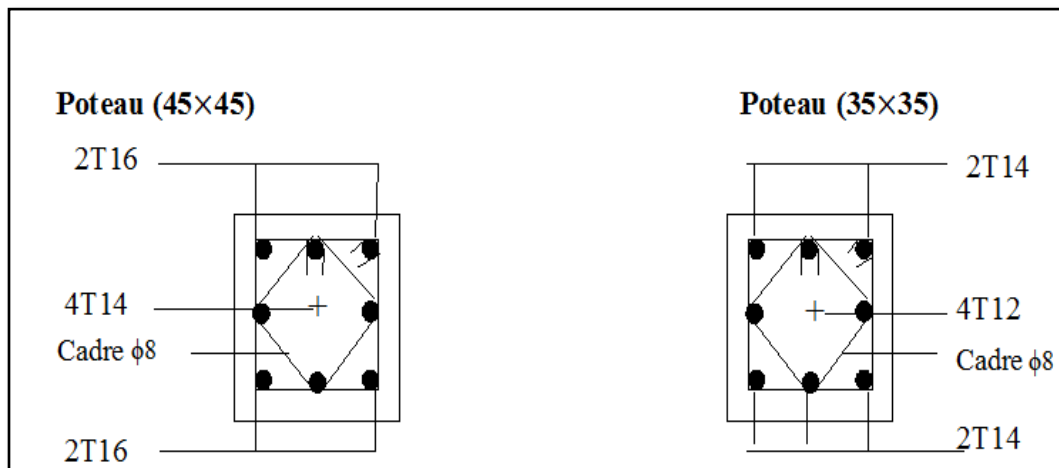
Ferrailage des poteaux des blocs A1, A2 et B1 de siège APC.
